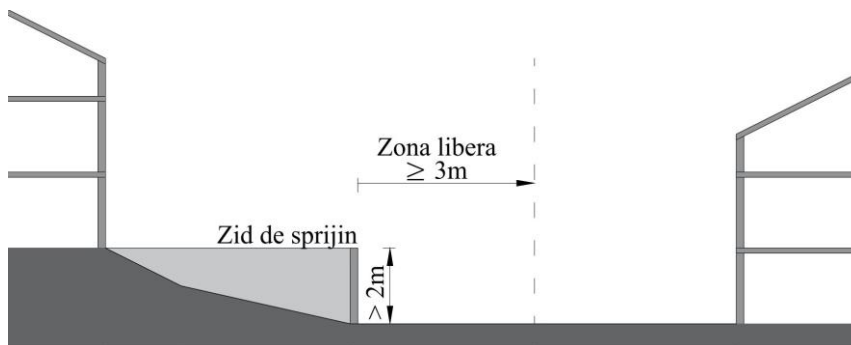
Perete de sprijin cu relevanță pentru zona liberă
